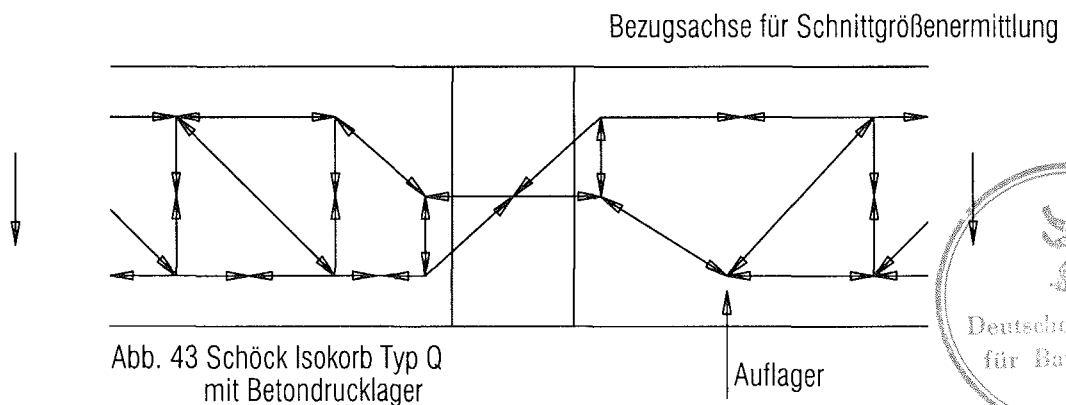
Schöck Isokorb Typ Q mit Betondrucklager
